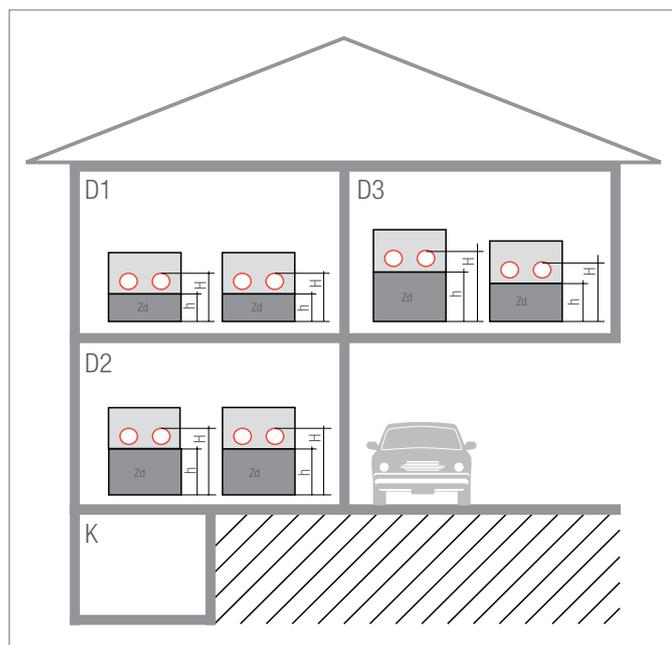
Isolation thermique minimale des planchers avec le système RAUFIX
